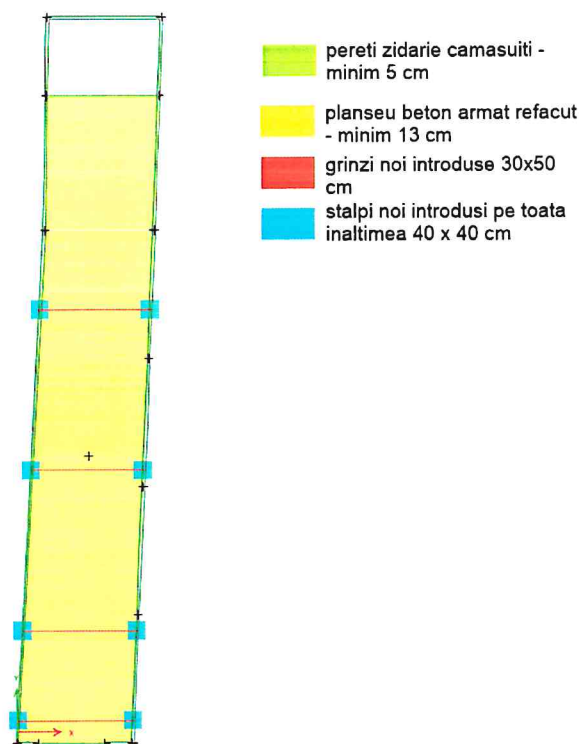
Identificare elemente nou introduse din beton armat planșeu peste parter
